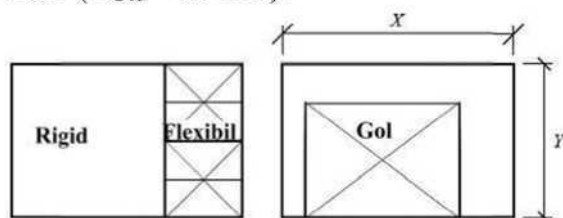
Planșee cu rigiditate nesemnificativă în plan (exemple de alcătuire)
